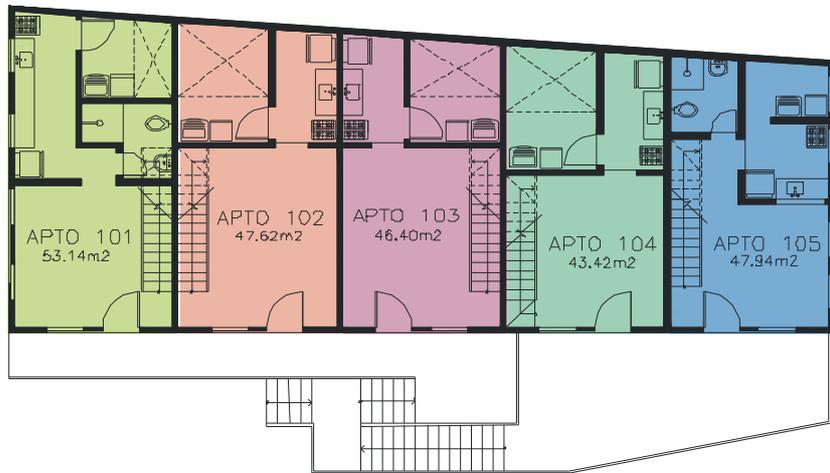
Planta do pavimento inferior na ladeira João Homem nº 35 – sem escala. PREFEITURA, 2007.
